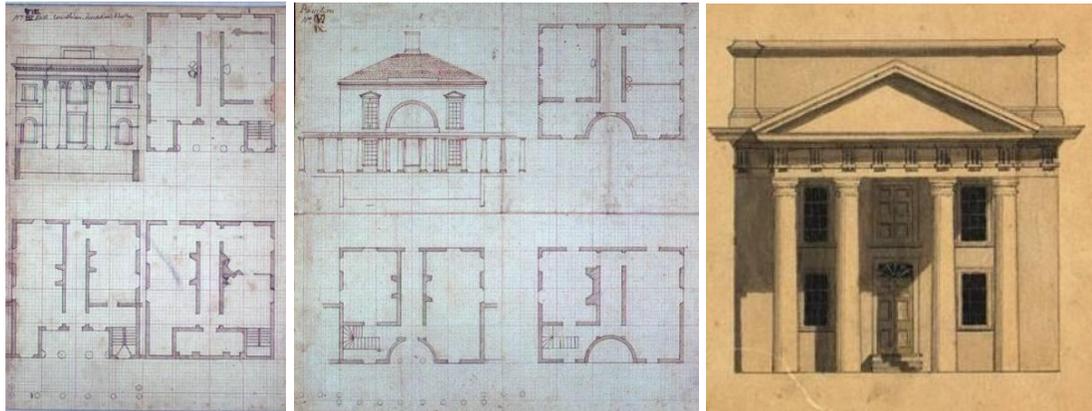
Pavilhão 8; Fig.: 98 – Pavilhão 9; Desenhos de Jefferson
